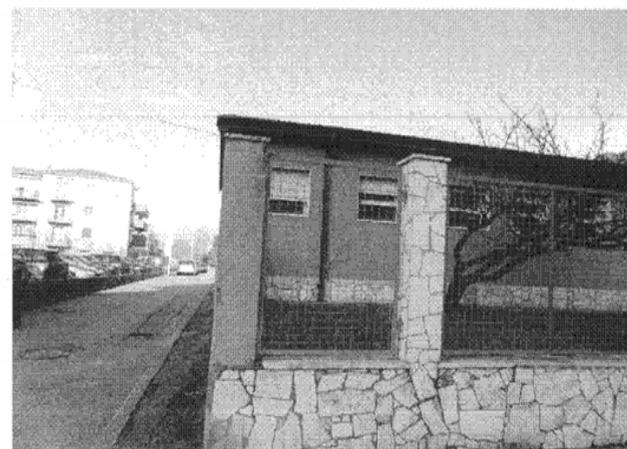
Foto del muretto di recinzione oggetto di modifica come descritto nella tav. n. 2 Planimetria generale (situazione di progetto)
